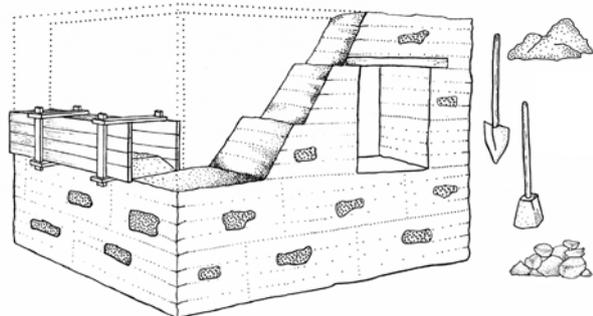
Tapia careada con piedra, empleando un mampuesto por cajón.
